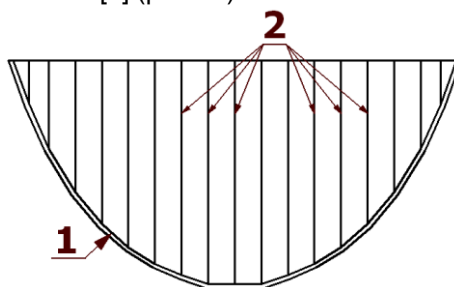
Схема расположения швов в железобетонном экране (вид с верхнего бьефа).
